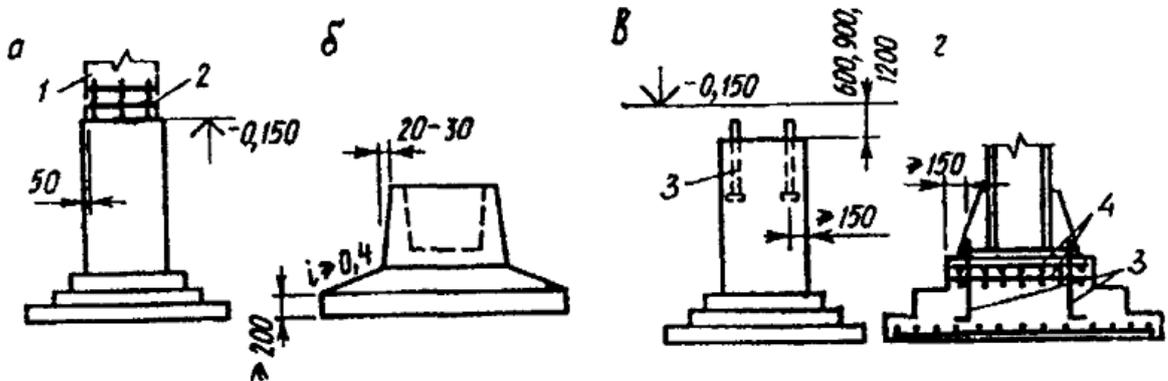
Типы монолитных фундаментов: а – под монолитную колонну; б – с подстаканником под сборную колонну; в – под сборную колонну с закладными деталями; г – под металлическую колонну;
